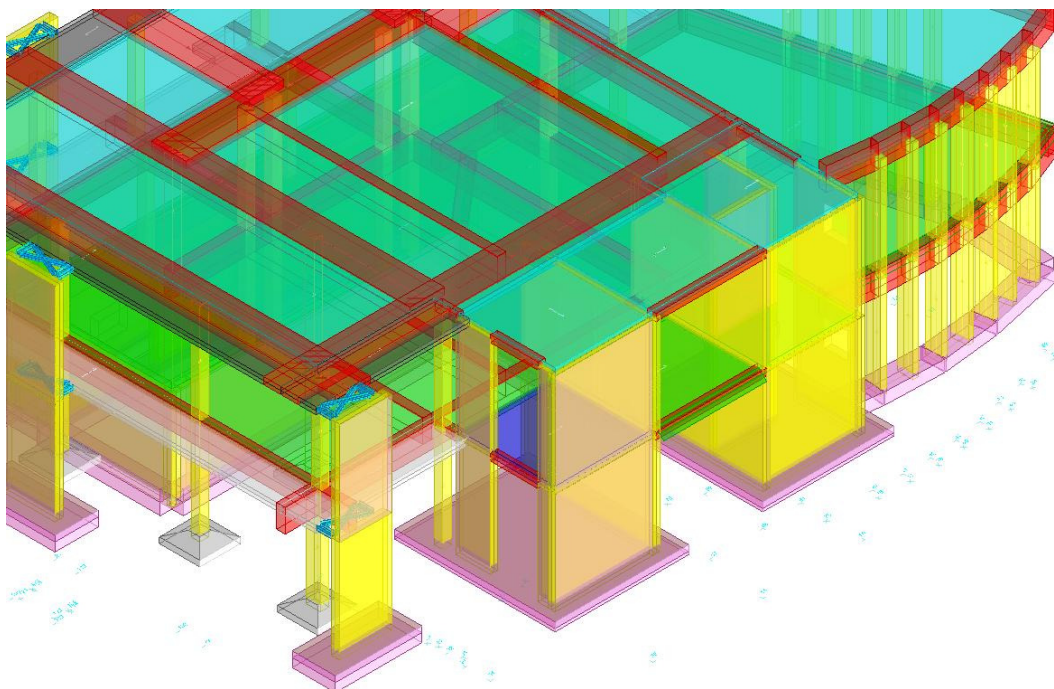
rappresentazione tridimensionale modello strutturale, vista 2
